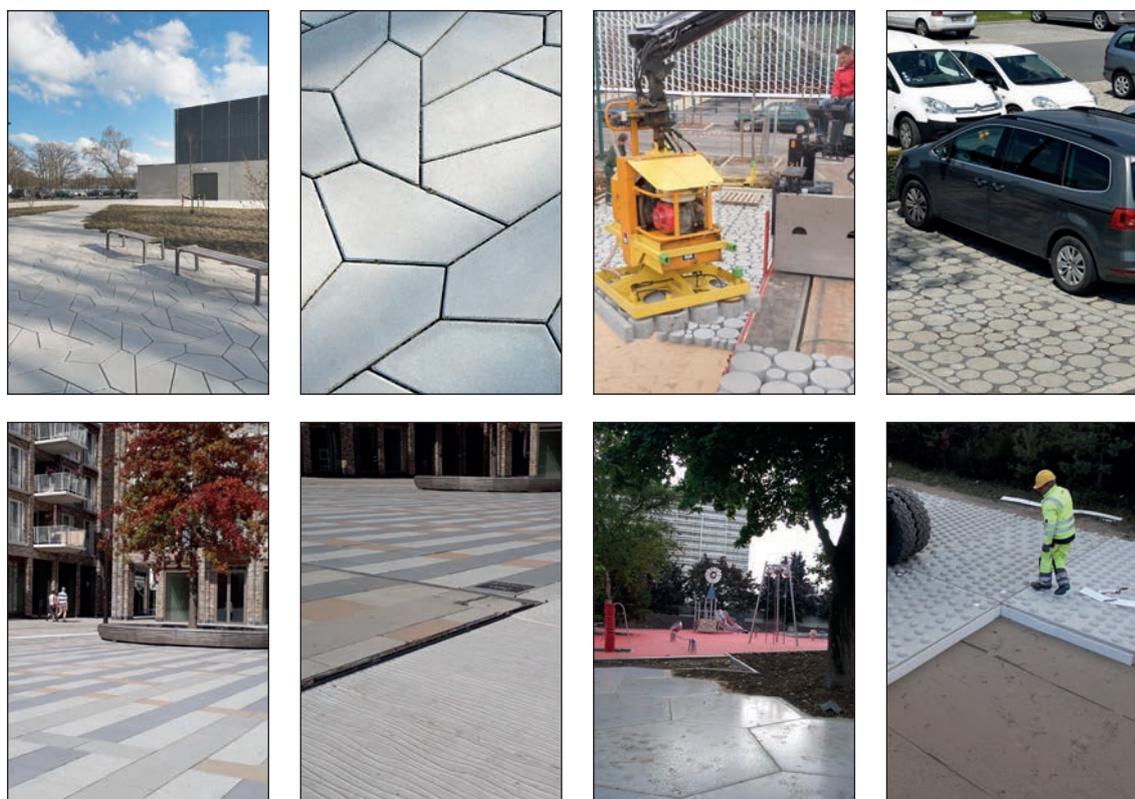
Quelques exemples de formes et/ou d'applications spécifiques avec des dalles de grand format et des dalles préfabriquées en béton
